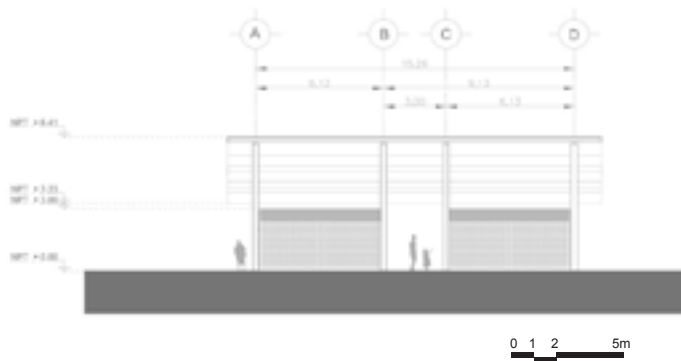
Planta arquitectónica de módulo de tipo del mercado.
